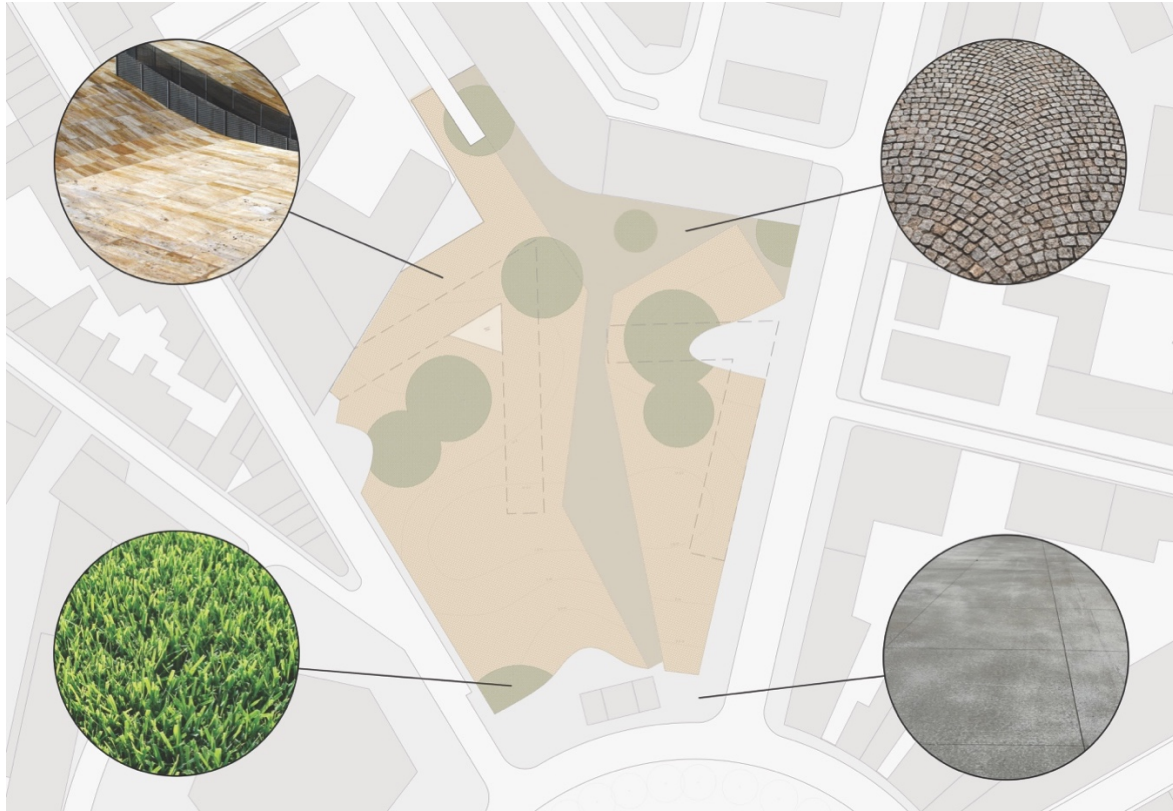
Planta com diferentes texturas ou pavimentos evidenciados.
